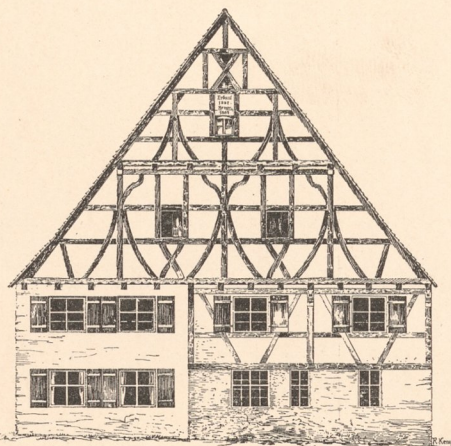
Bauernhaus Nr. 127 in Babenhausen. Strassenansicht.
